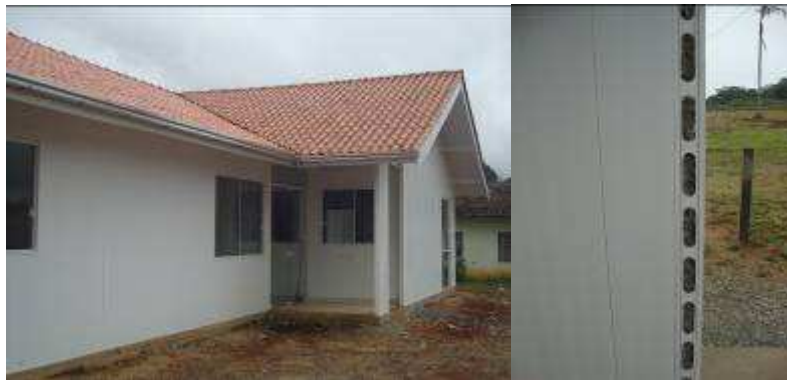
CASA EM SISTEMA DE PAREDES DE CONCRETO COM FORMA DE PVC RÍGIDO, NO ESTADO DE SANTA CATARINA
